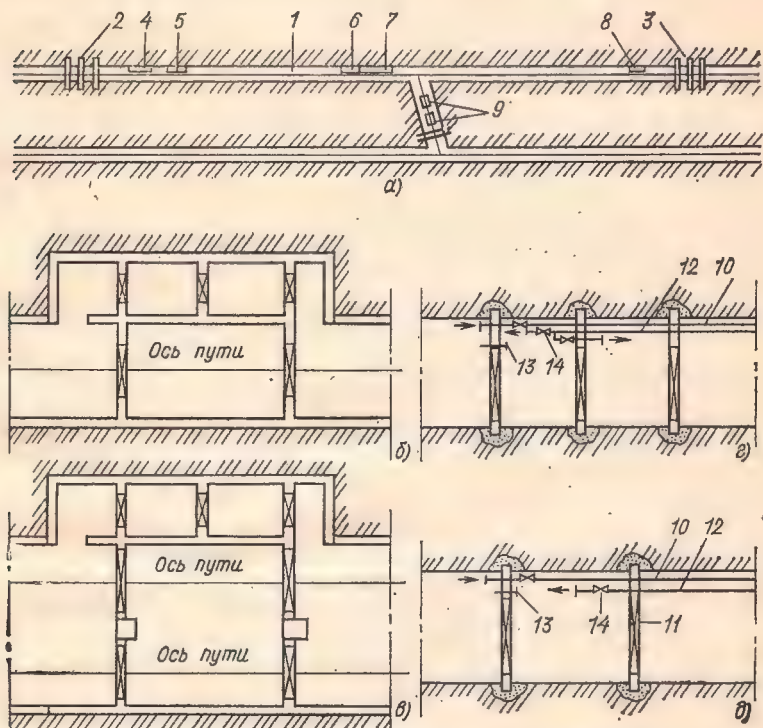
Вариант расположения убежища в горной выработке. Схема защитных узлов:
